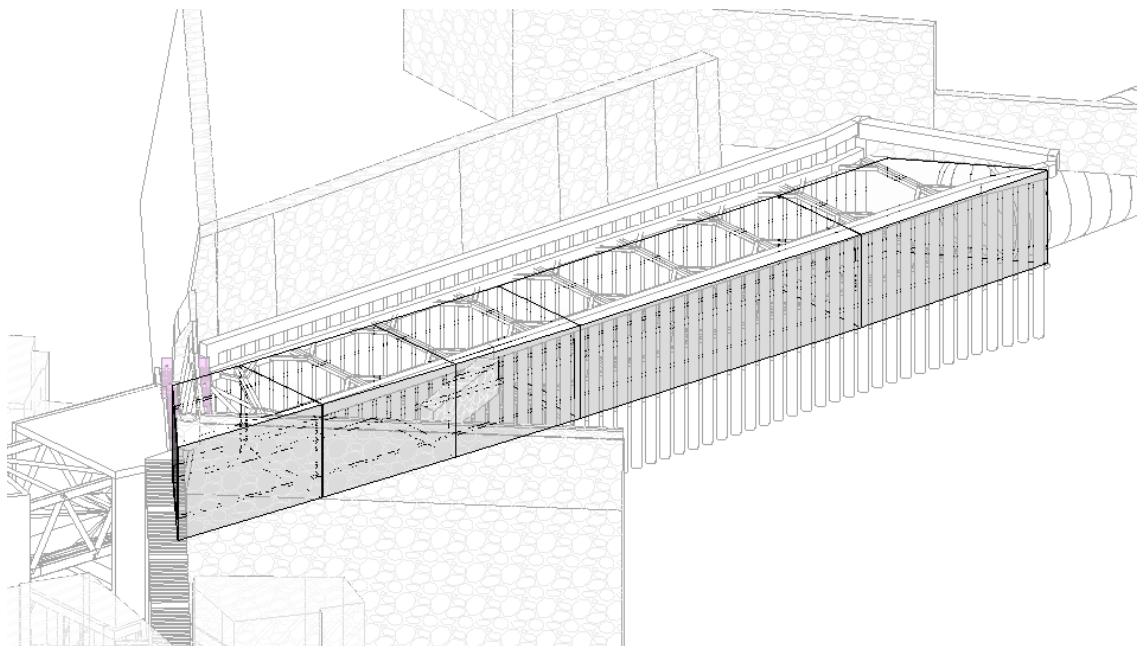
Vista 3D da solução definitiva do Túnel do Metro
